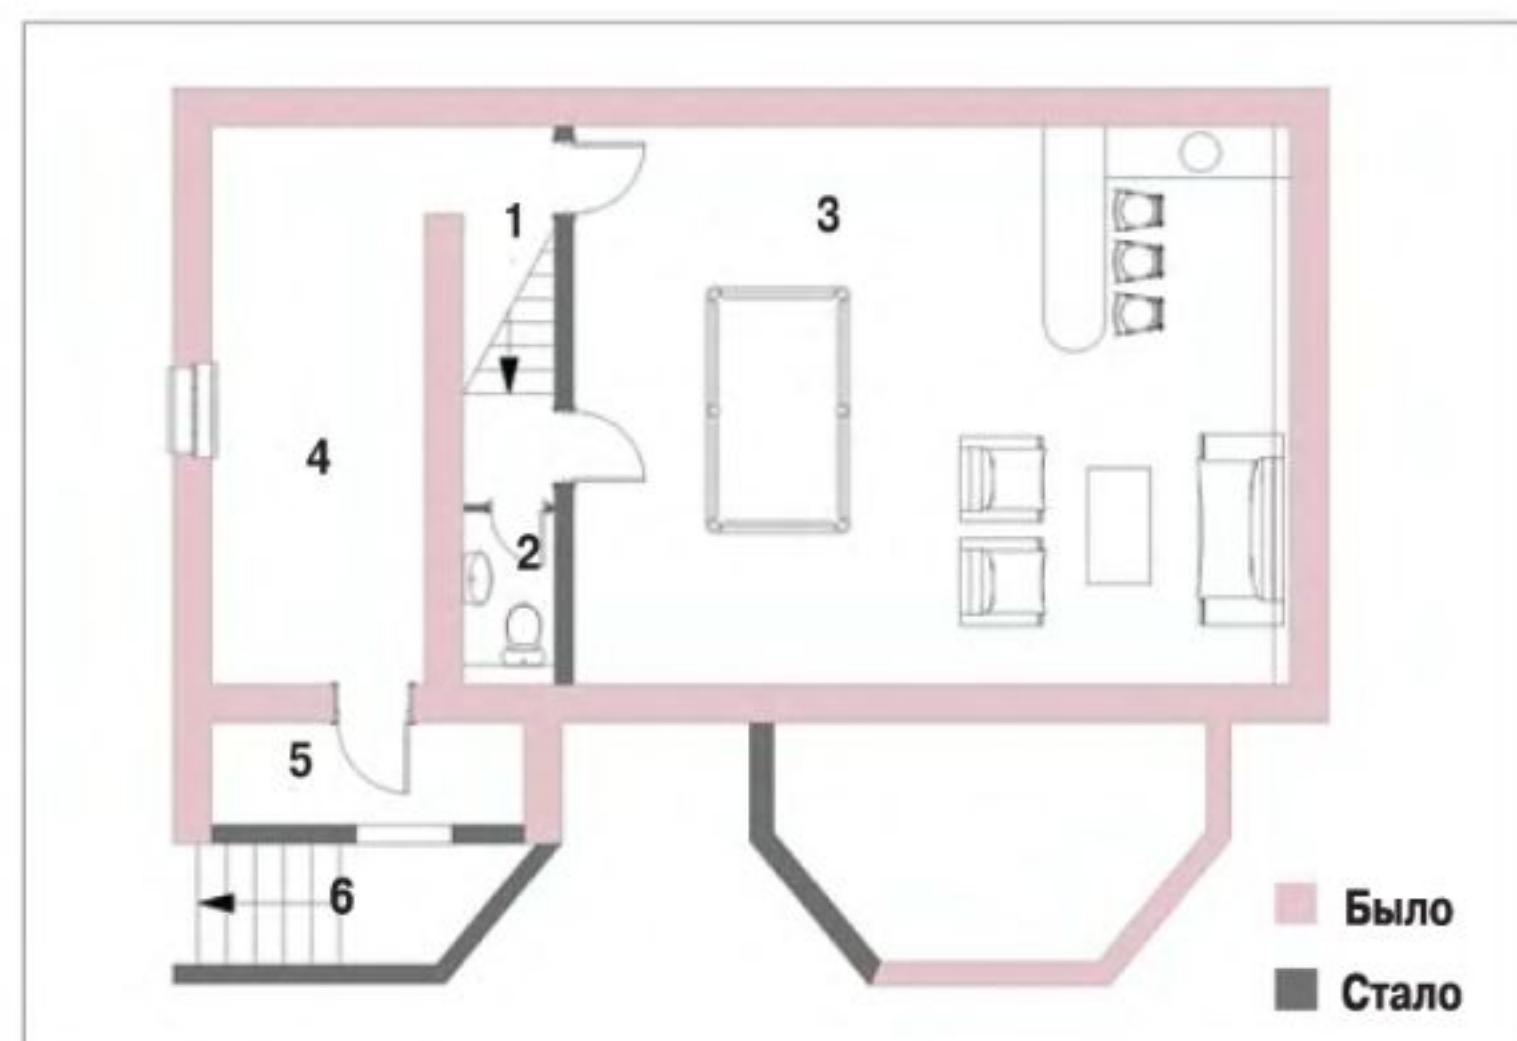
План цокольного этажа: 1 — кладовая 3,0 м² под лестницей; 2 — кладовая или санузел 1,7 м²; 3 — бильярдная 44,5 м²; 4 — котельная 13,0 м²; 5 — кладовая 3,5 м²; 6 — лестница в цокольный этаж с участка.
